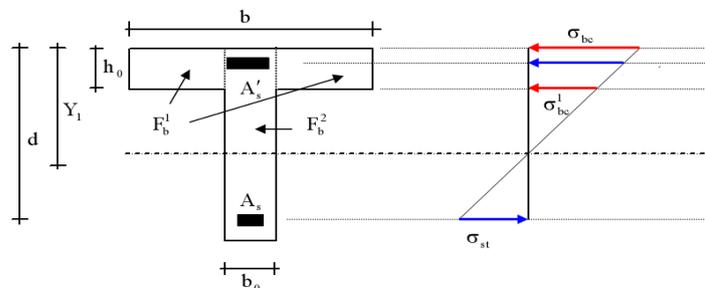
notation utilisées pour le calcul de section d'acier pour une poutre en T
